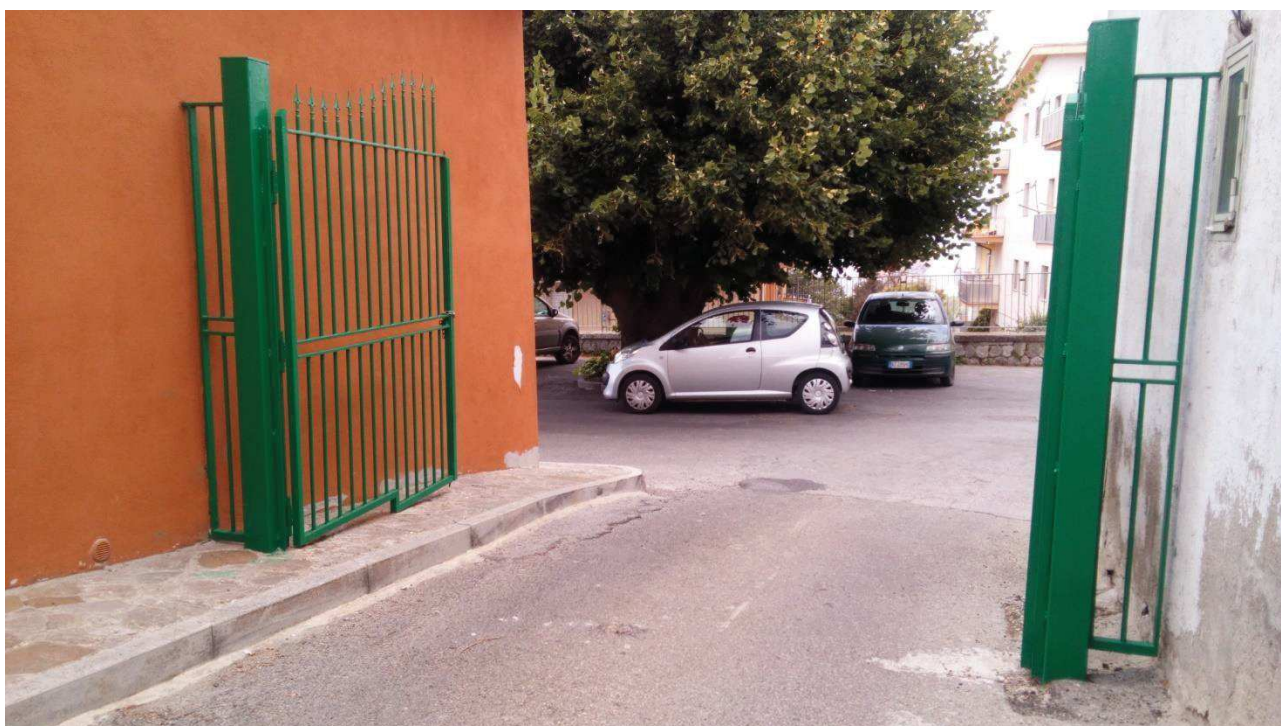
[Plesso San Pietro] Situazione del cancello d'ingresso post operam.
